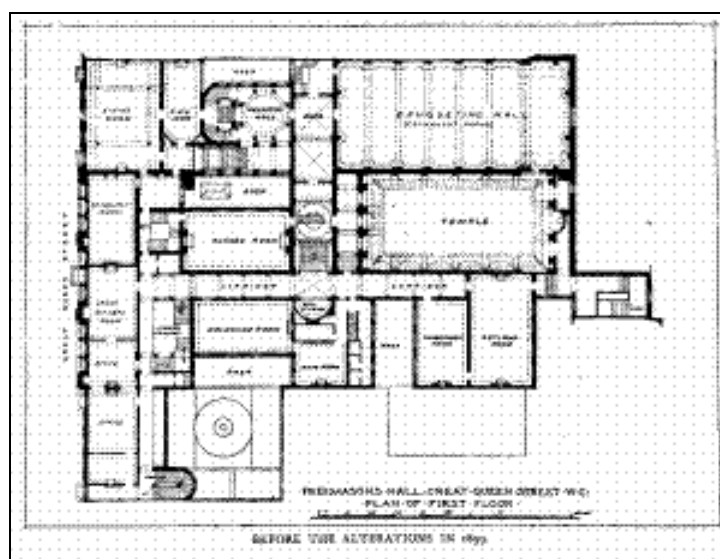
Primer Templo Masónico de Londres, diseñado en 1775 y construido en 1811. Plano de planta (Fuente: <http://www.freemasonry.london.museum/resources/history-of-freemasons-hall/> . Consulta 02-04-2012.
